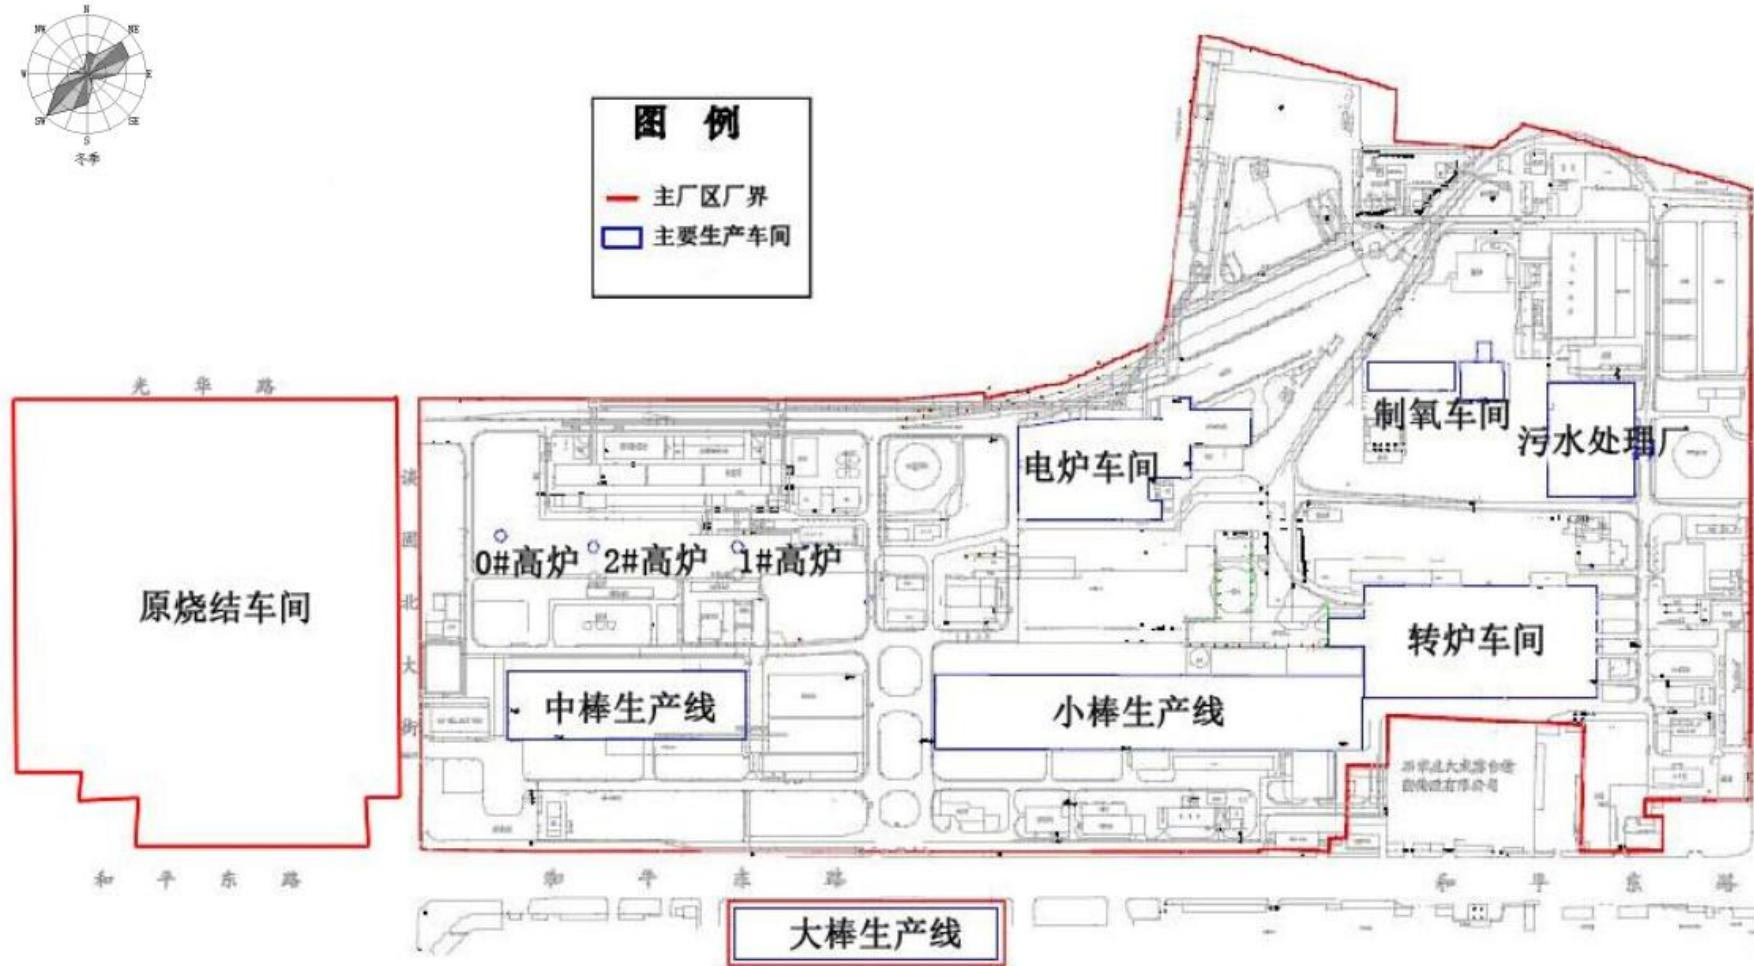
石家庄钢铁公司主厂区厂区平面图
